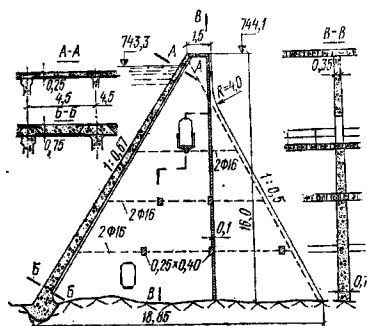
Тонкостенная плотина с плоскими напорными плитами и теплоизоляционной стенкой
